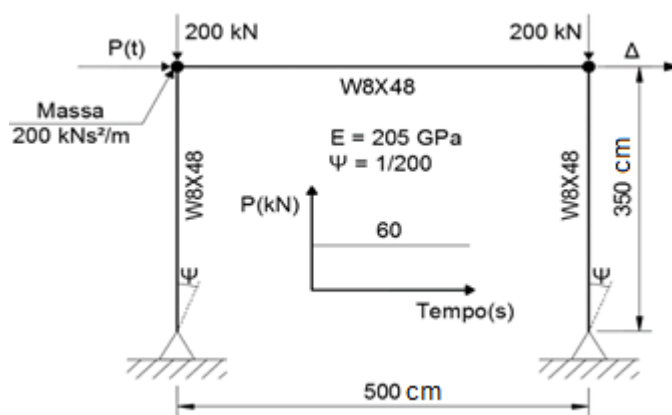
Configuração e propriedades do pórtico simples biapoado
